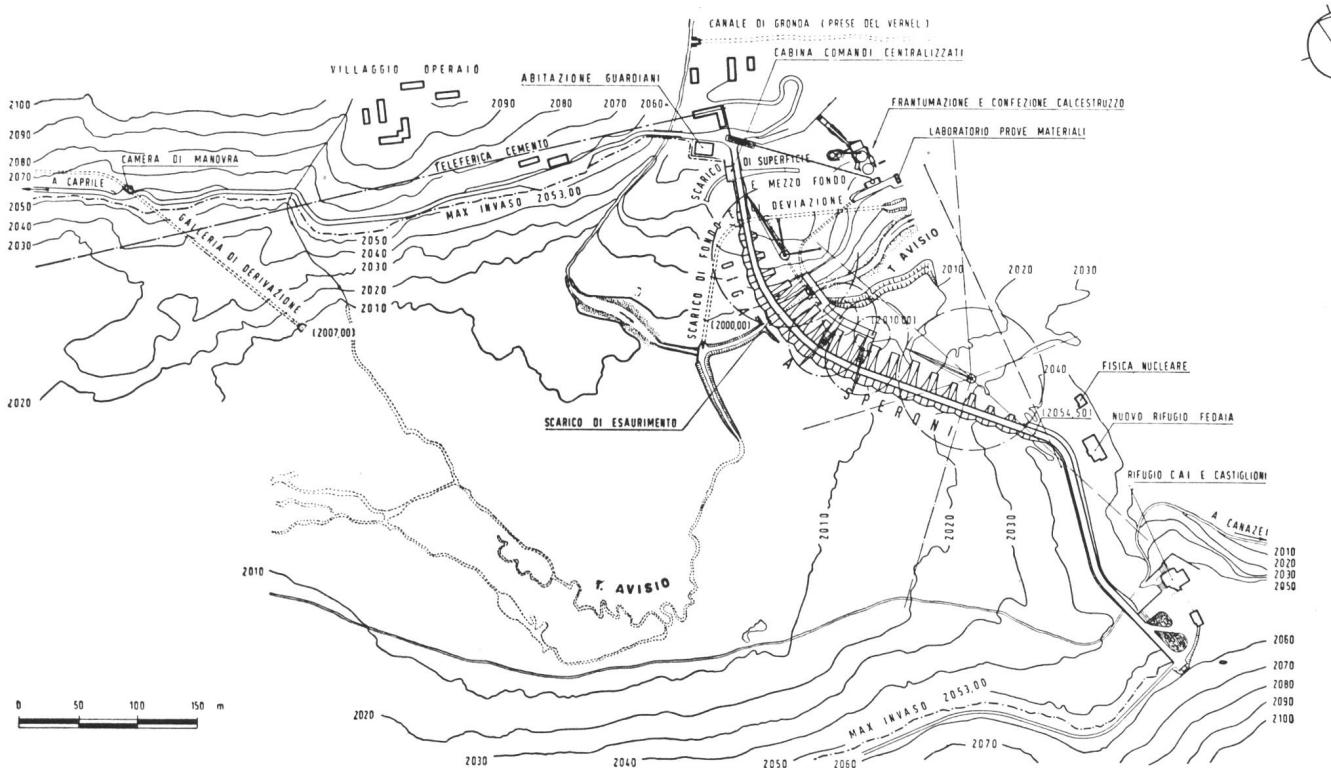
Lageplan Pfeiler-Staumauer Fedaia
